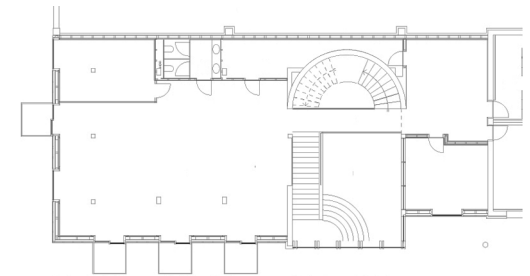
Pianta piano primo; Fonte: www.archinfo.it;
